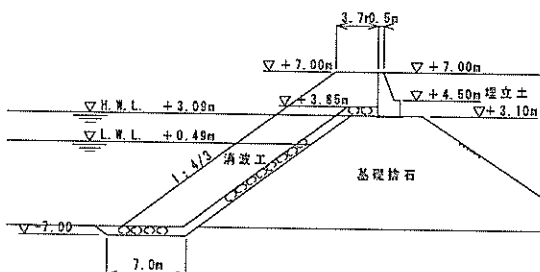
三田尻中関港廃棄物埋立護岸 標準断面図
